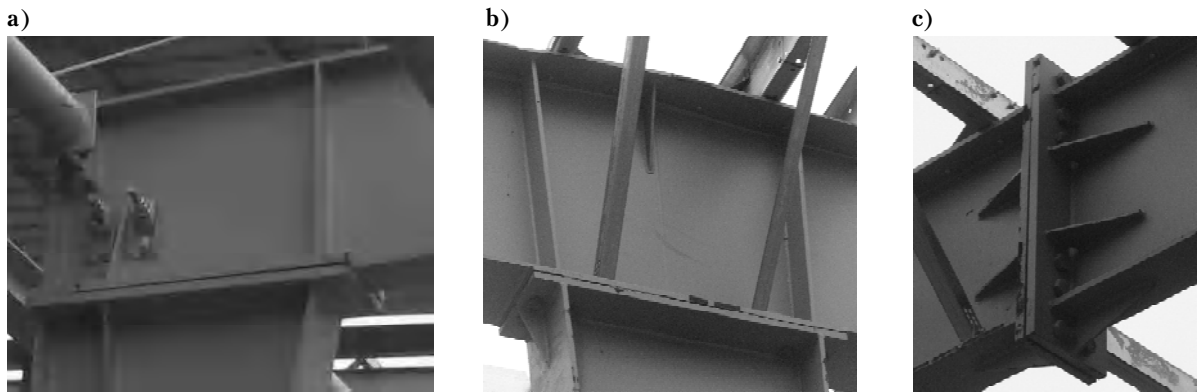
Фланцевые соединения рамных узлов: а) сопряжение крайней колонны с ригелем; б) сопряжение средней колонны с ригелем; в) монтажный стык ригеля (фото предоставлены компанией ASTRON Buildings S.A.).
